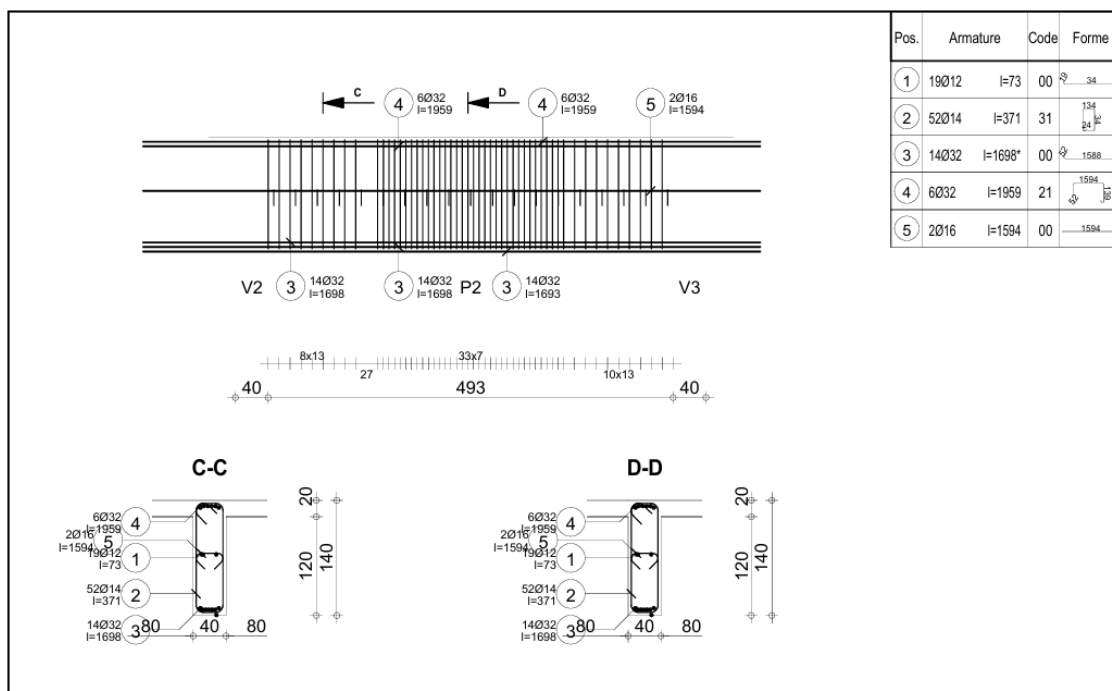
36 - Section en T de l'entretoise avec plan de ferrailage (méthode de poutres droites).
